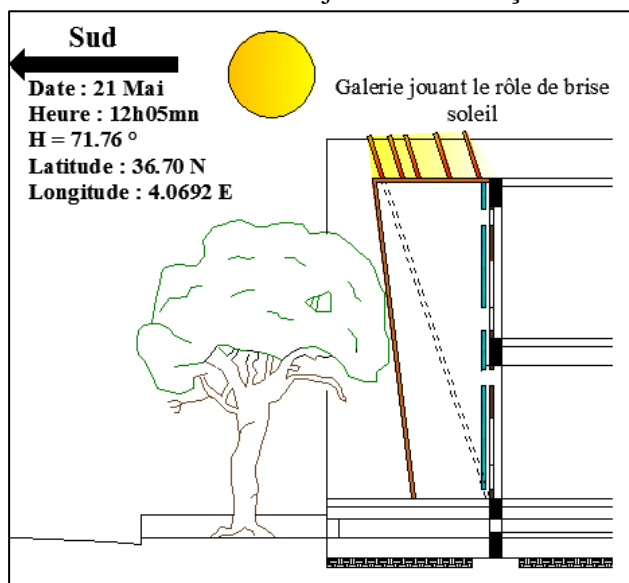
Protection solaire de la façade Sud-Est du bloc «A».
